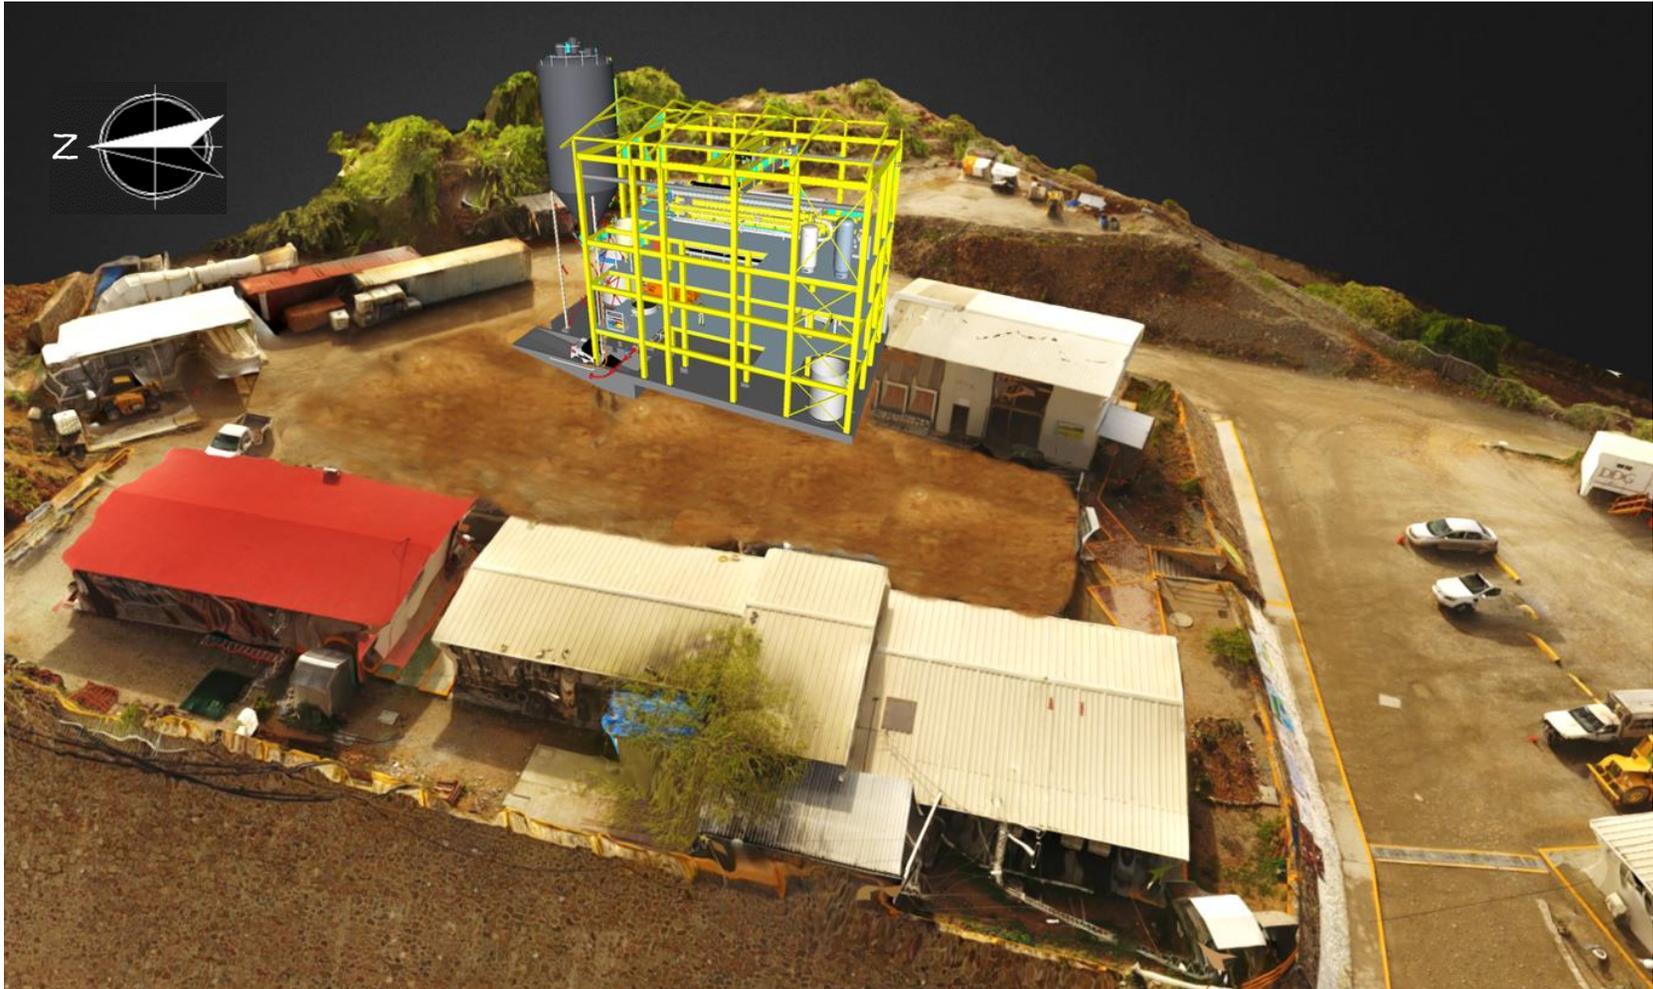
c.- Vista del escenario actual del sitio con la planta de pasta sobrepuesta en 3D.
